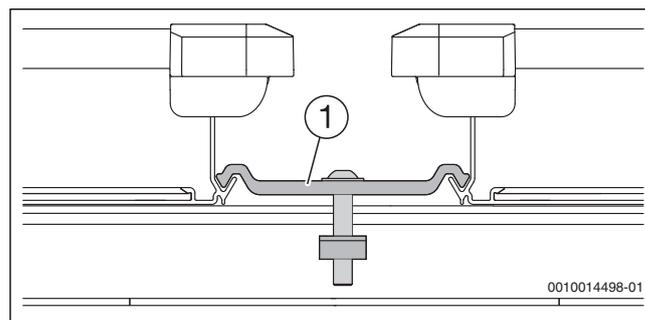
Giunto di collegamento e fissaggio bilaterale
